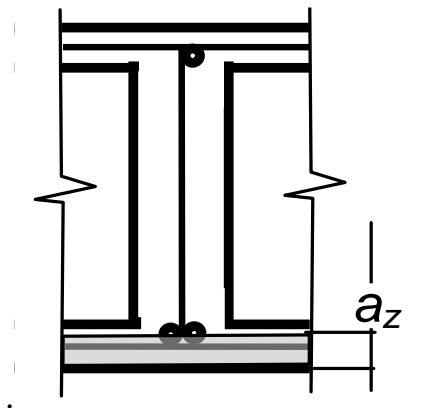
Розрахункова схема перерізу плити перекриття із ушкодженою зоною
